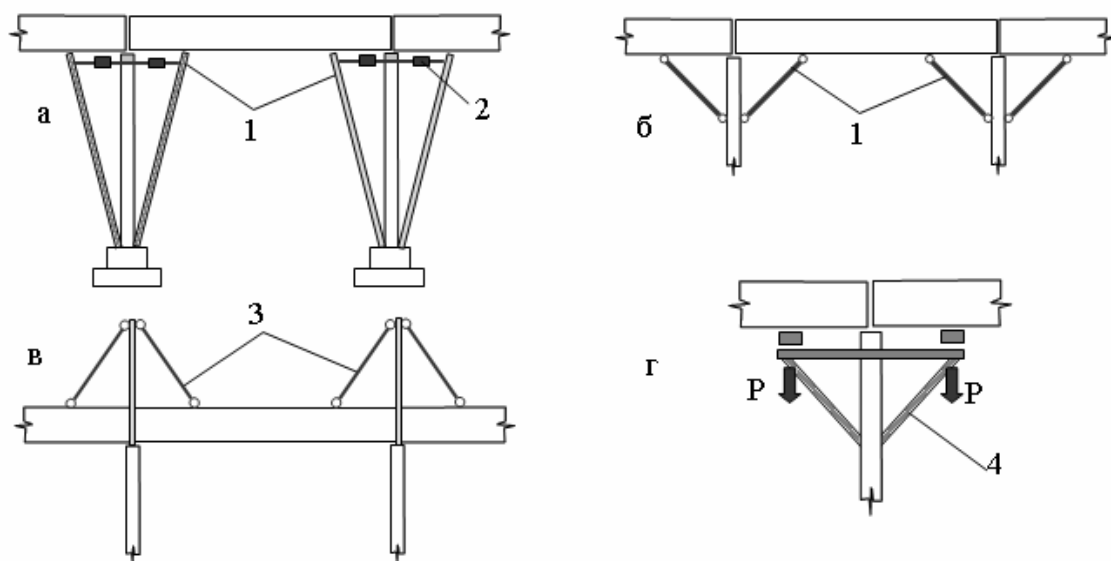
Схемы усиления стальных балок дополнительными жесткими и упругими опорами: *а* – предварительно напряженными подкосами с опиранием на фундаменты; *б* – подкосами с опиранием на колонну; *в* – подвесками; *г* – предварительно напряженными кронштейнами: 1 – подкосы, 2 – затяжка с натяжным приспособлением, 3 – подвески, 4 – кронштейны
